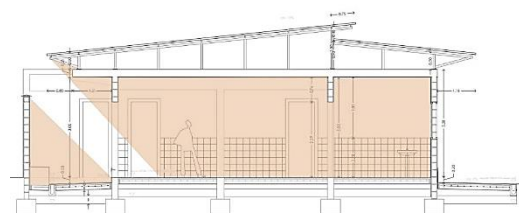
SOMBRAS DE ALERO Y MURO (A.C.R.)
